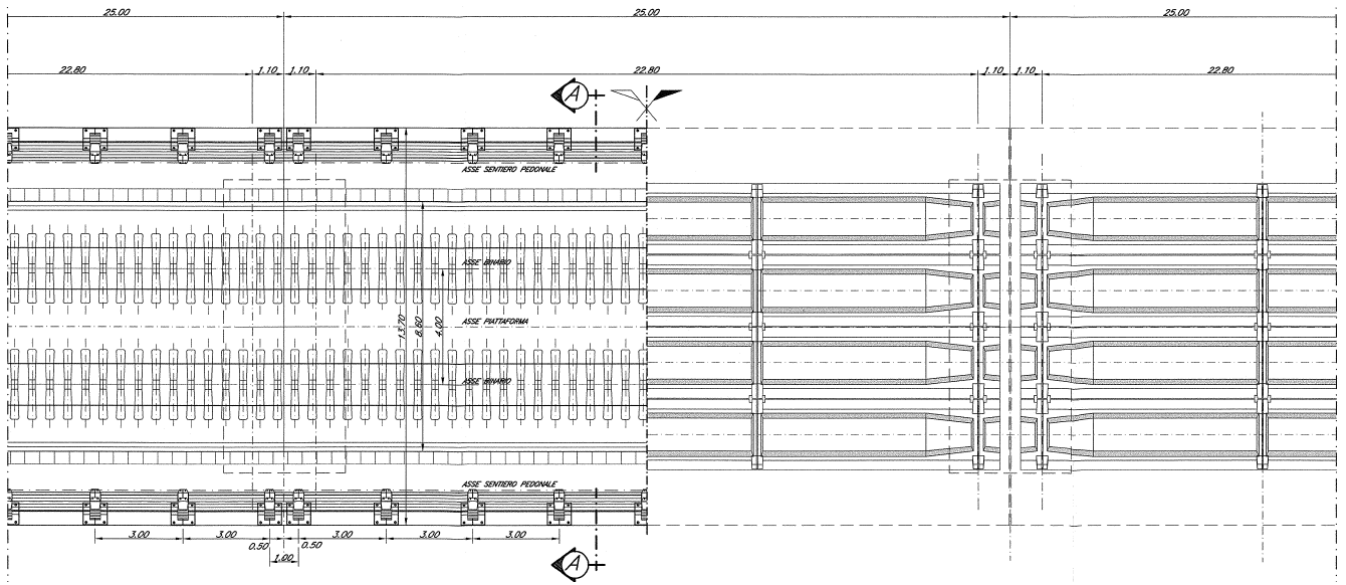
Pianta tipo viadotto c.a.p. L=25.00m
